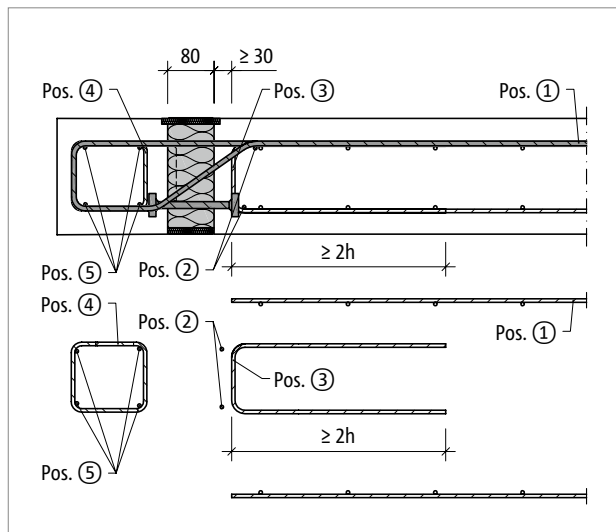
Schöck Isokorb® T Typ OP: Bauseitige Bewehrung
